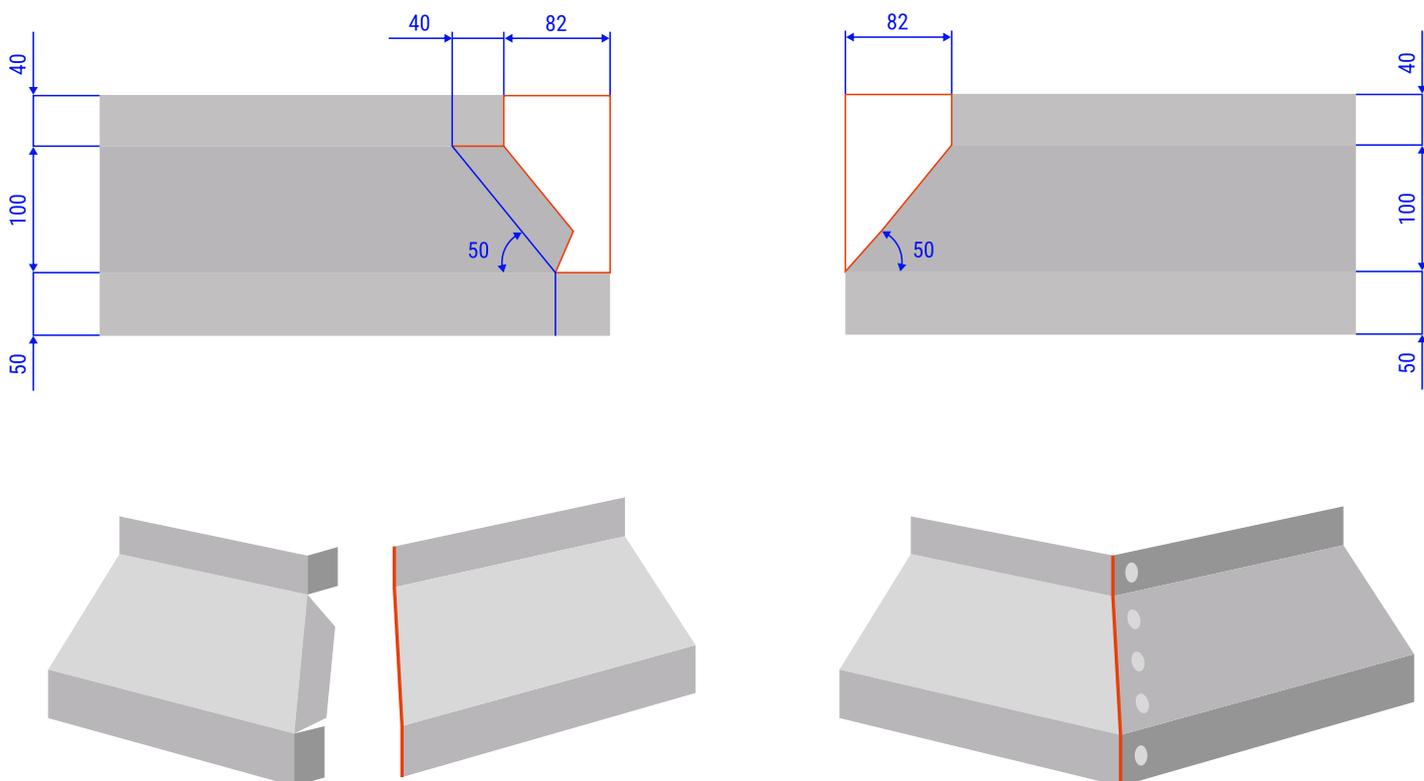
Устройство внешнего угла здания на уровне цоколя
